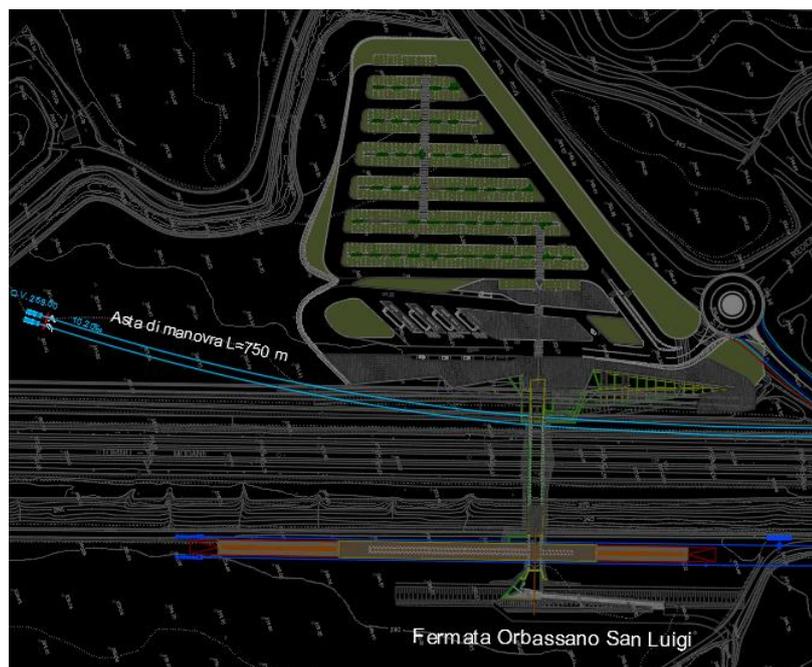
Estrapolazione dal file Autocad del progetto della fermata Orbassano San Luigi
